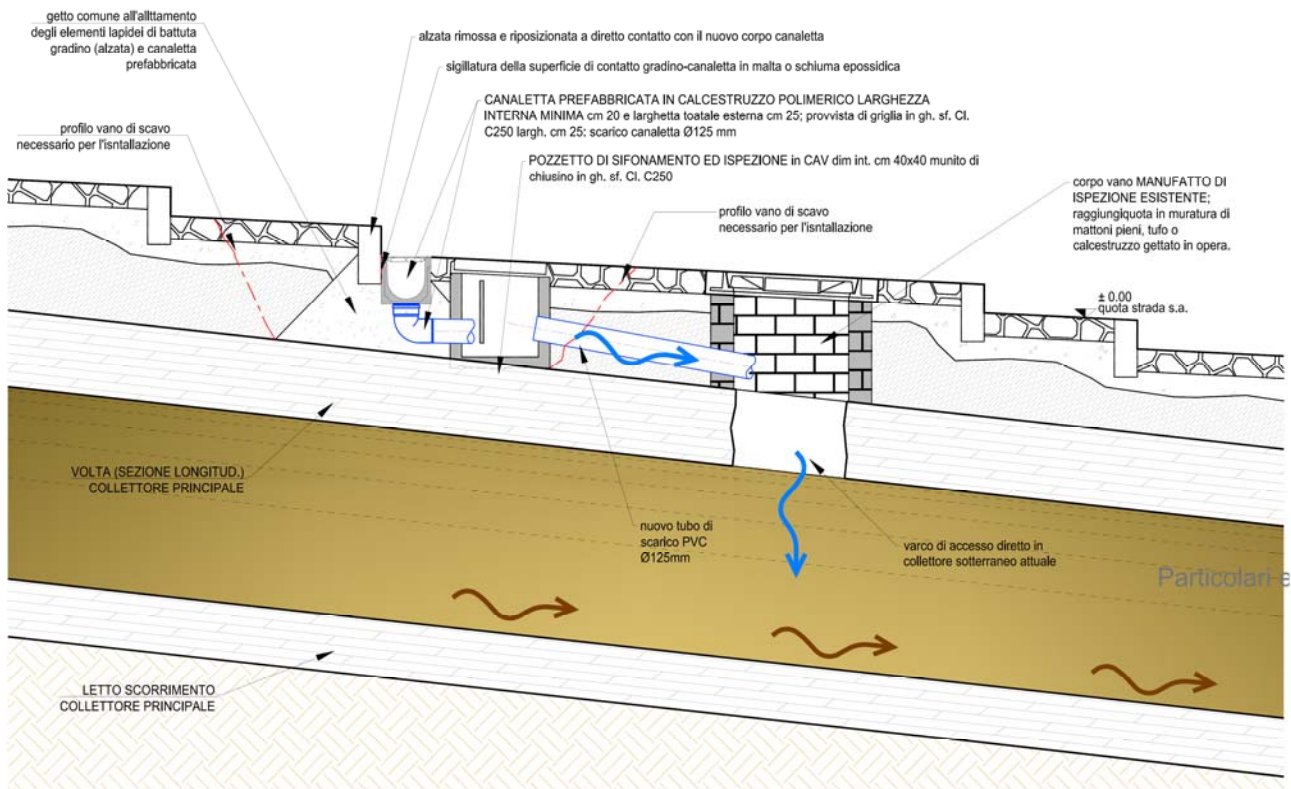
inserimento di canalette a ridosso delle alzate gradinate esistenti
